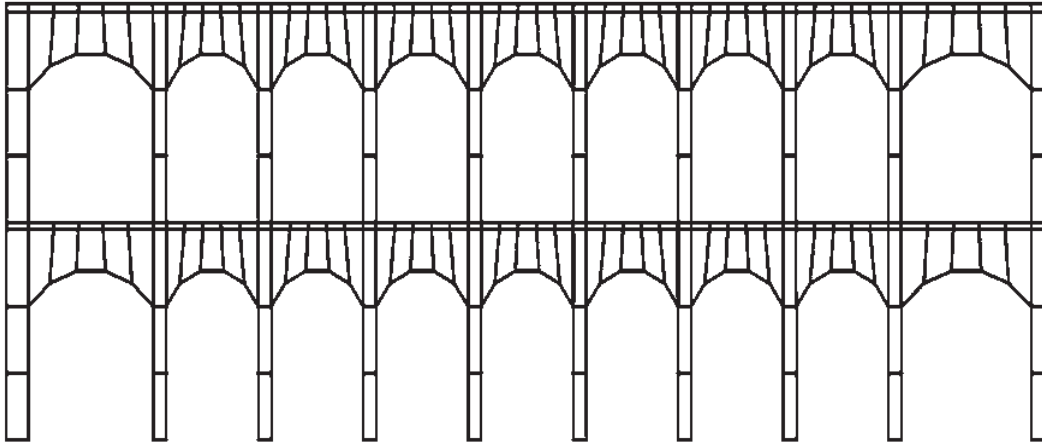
Modelo de elementos rígidos para la arcada Norte del primer patio.
